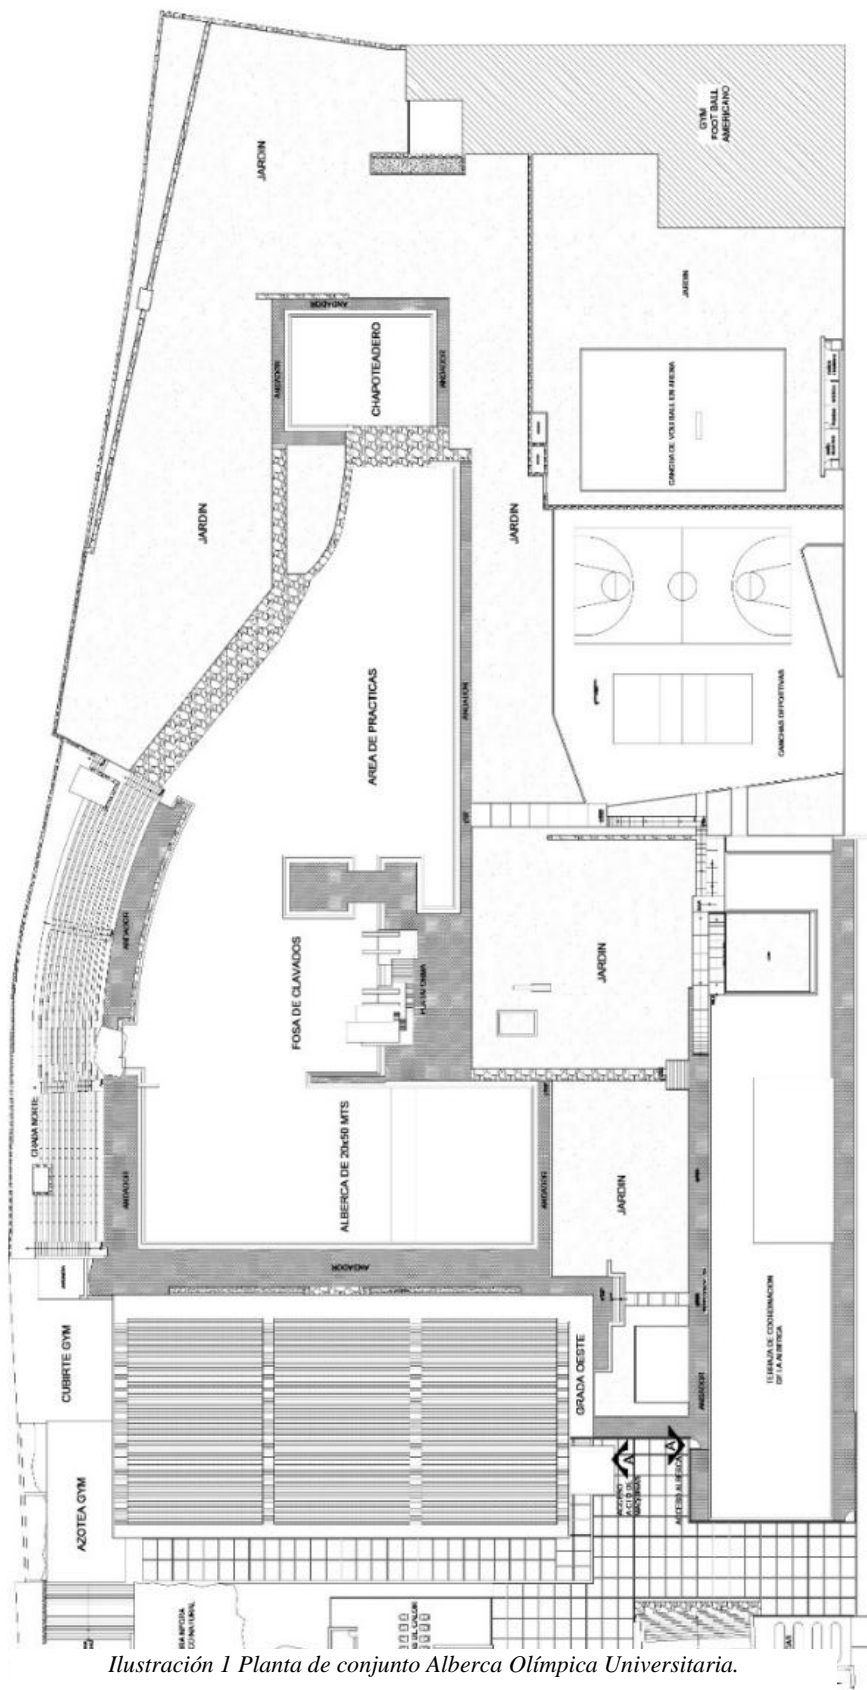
Planta de conjunto Alberca Olímpica Universitaria.
